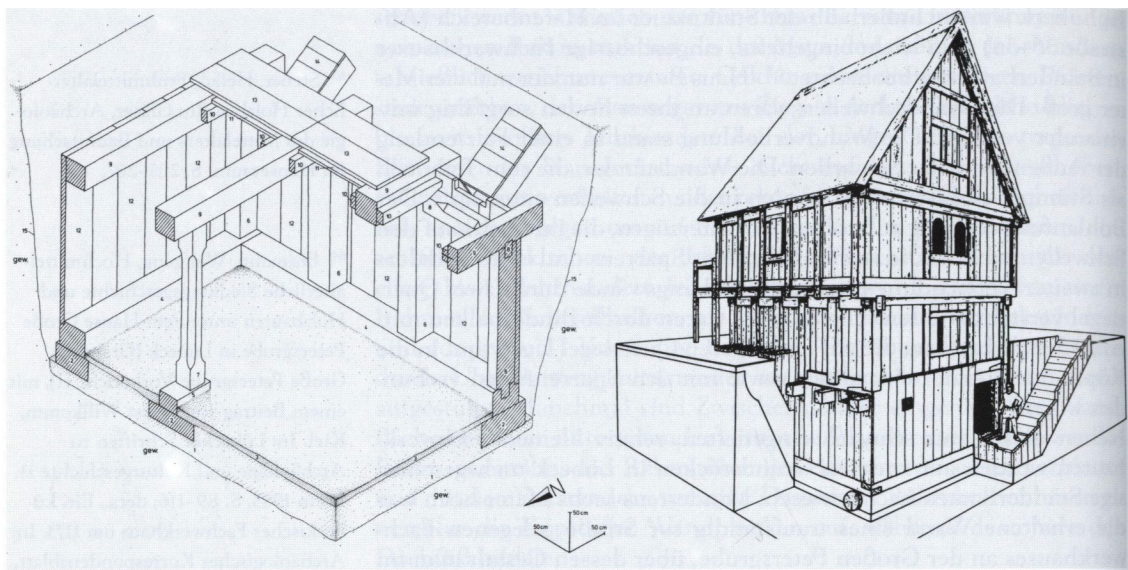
Gebäudegrundriss und Ansicht der Rekonstruktion des Befundes der nordwestlichen Traufenwand, sowie des Verbands zwischen Pfosten und Schwellriegel
